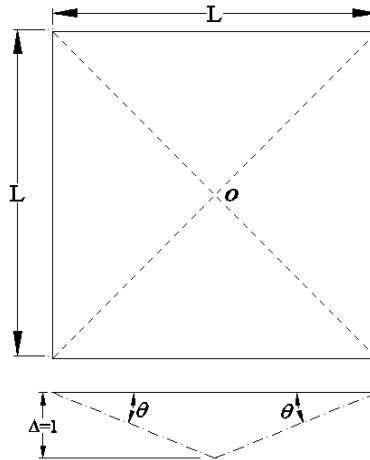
Configuración deformada de una losa cuadrada en dos direcciones con carga uniformemente distribuida, de la cual se calcula el trabajo interno
